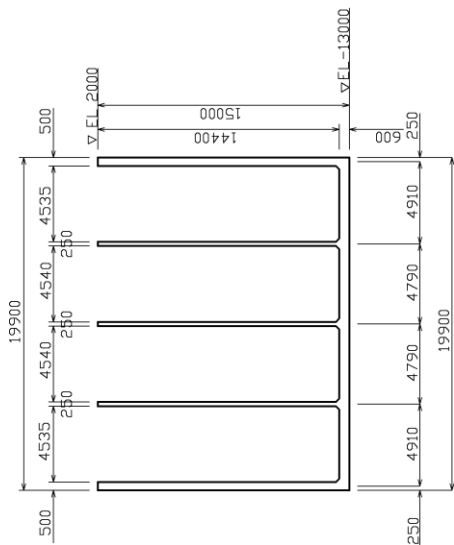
(2) 防波壁 (波返重力擁壁) のケーソン構造図 (②-②断面)
